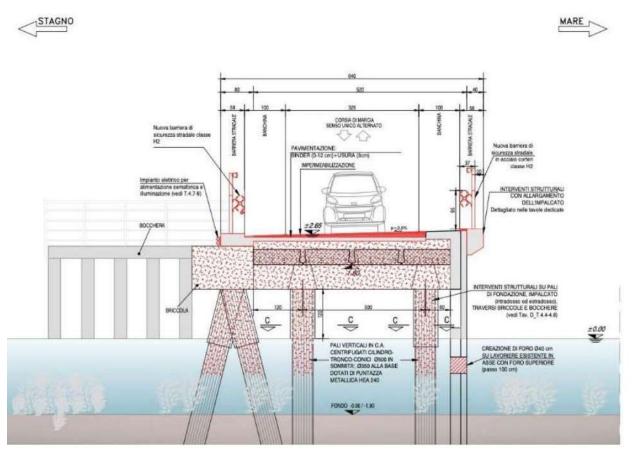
Sezione trasversale stato di progetto tratto da Accesso NORD a molo lato mare
